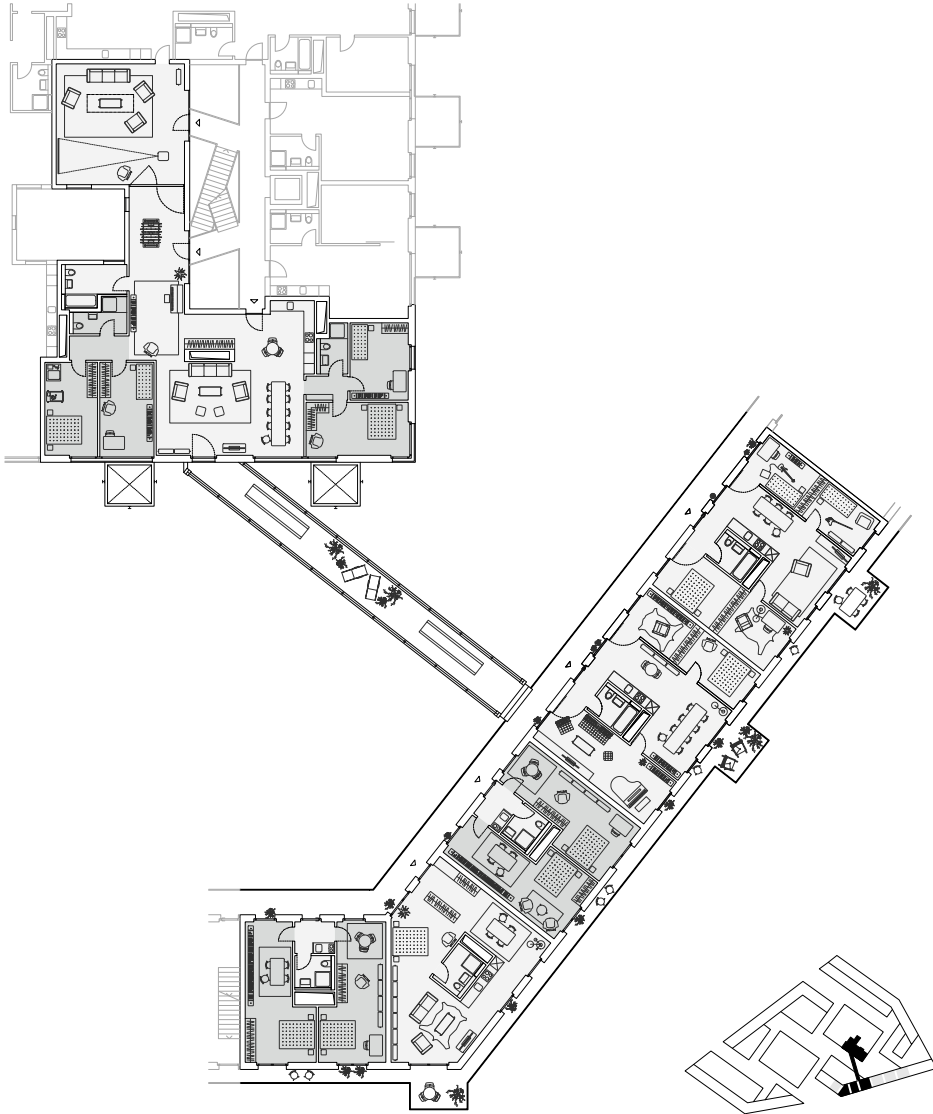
Kraftwerk1 Zwicky Süd, Grundriss Brückenwohnung, Schneider Studer Primas Architekten Zürich
